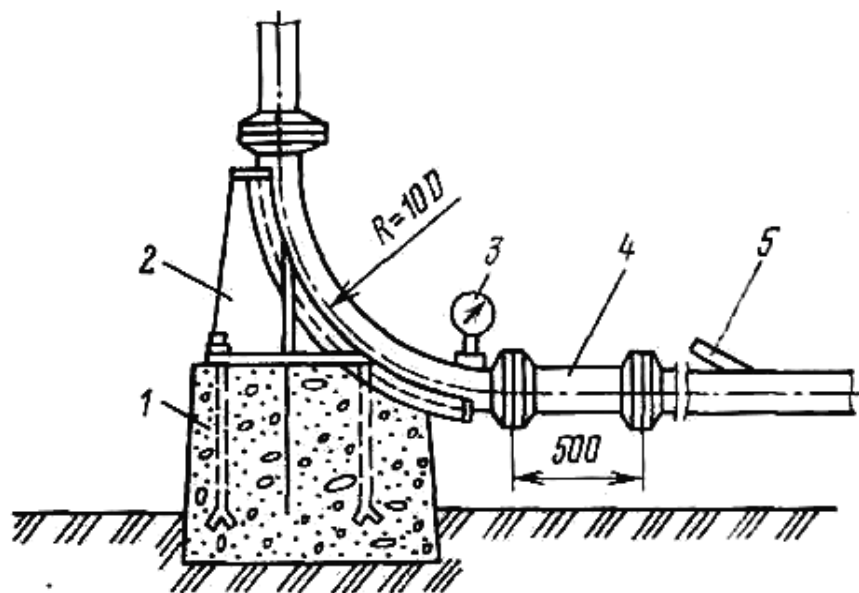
Схема крепления закладного трубопровода: 1 — бетонное основание; 2 — упор; 3 — манометр; 4 — фланцевая вставка; 5 — сопло пневмоэжектора
